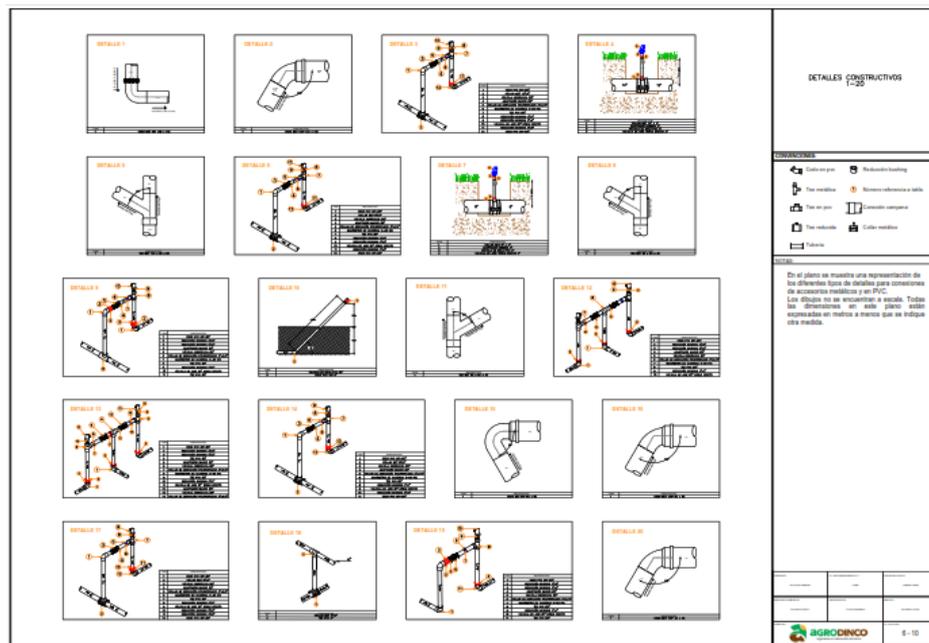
Detalles constructivos del sistema de riego - Proyecto Plan Parejo. Fuente: Agrodinco SAS.
